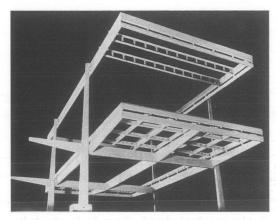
Prototipo para una casa prefabricada realizado en colaboración con E. Beaudouin y M. Lods (Sulze 2000)
